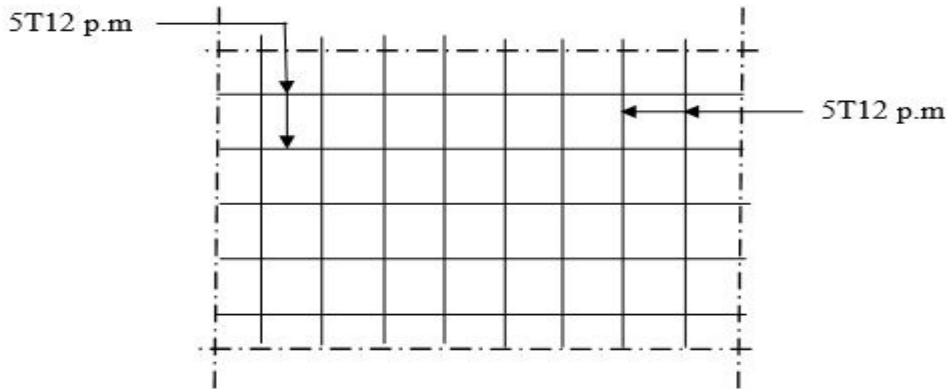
Dispositions Du Ferrailage Du Voile
